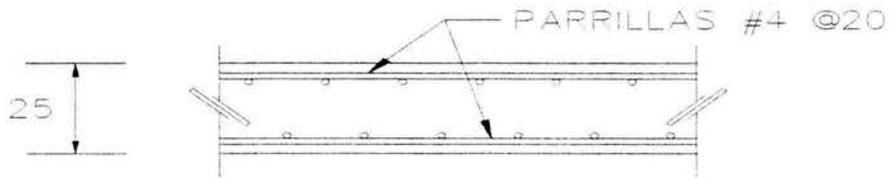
Refuerzo de acero en losa de fondo (cimentación).
